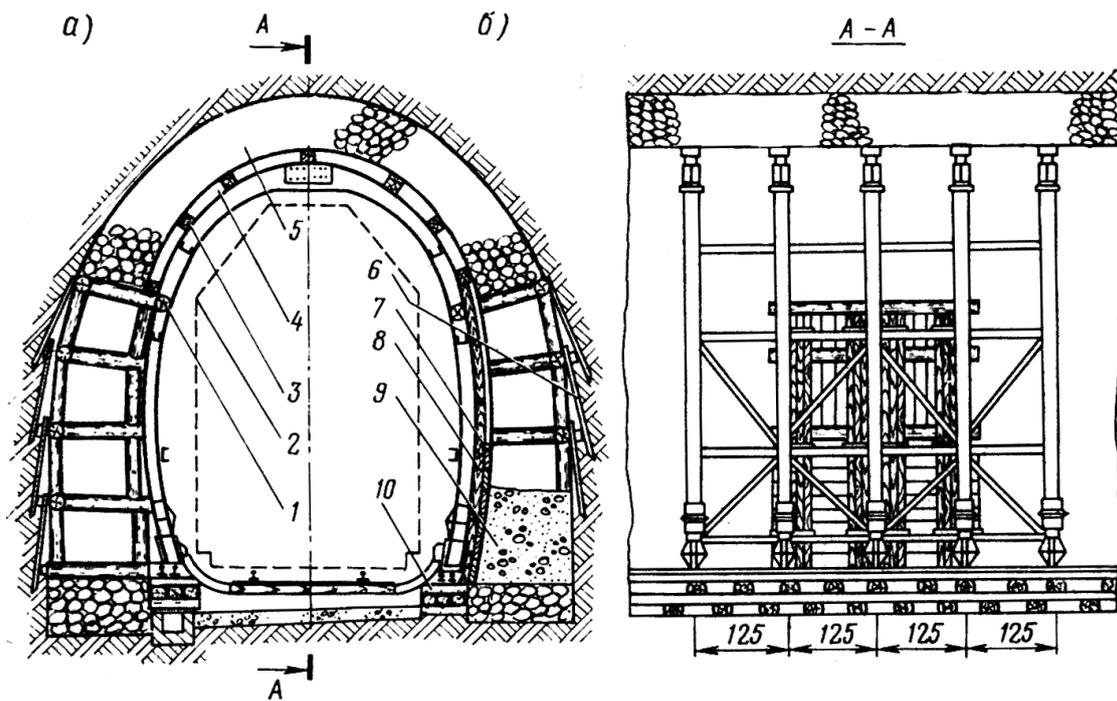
Перекладка стен тоннеля, расположенного в слабых породах:
